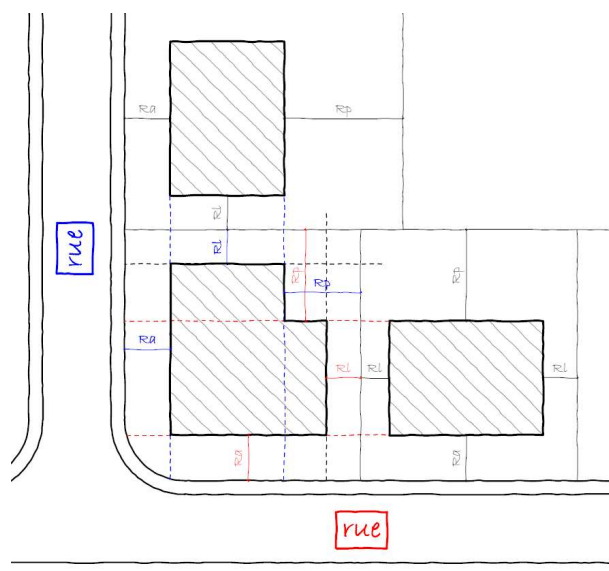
détermination des reculs pour les constructions aux angles de rues
